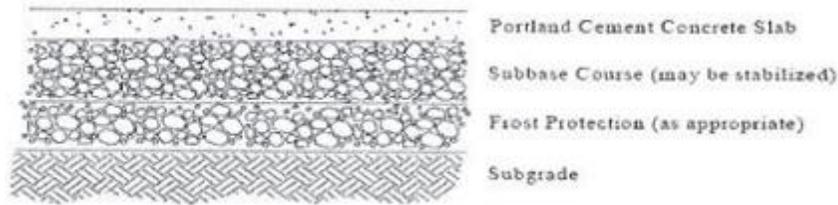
Transferencia de carga de una rueda en una estructura de pavimento rígida.
